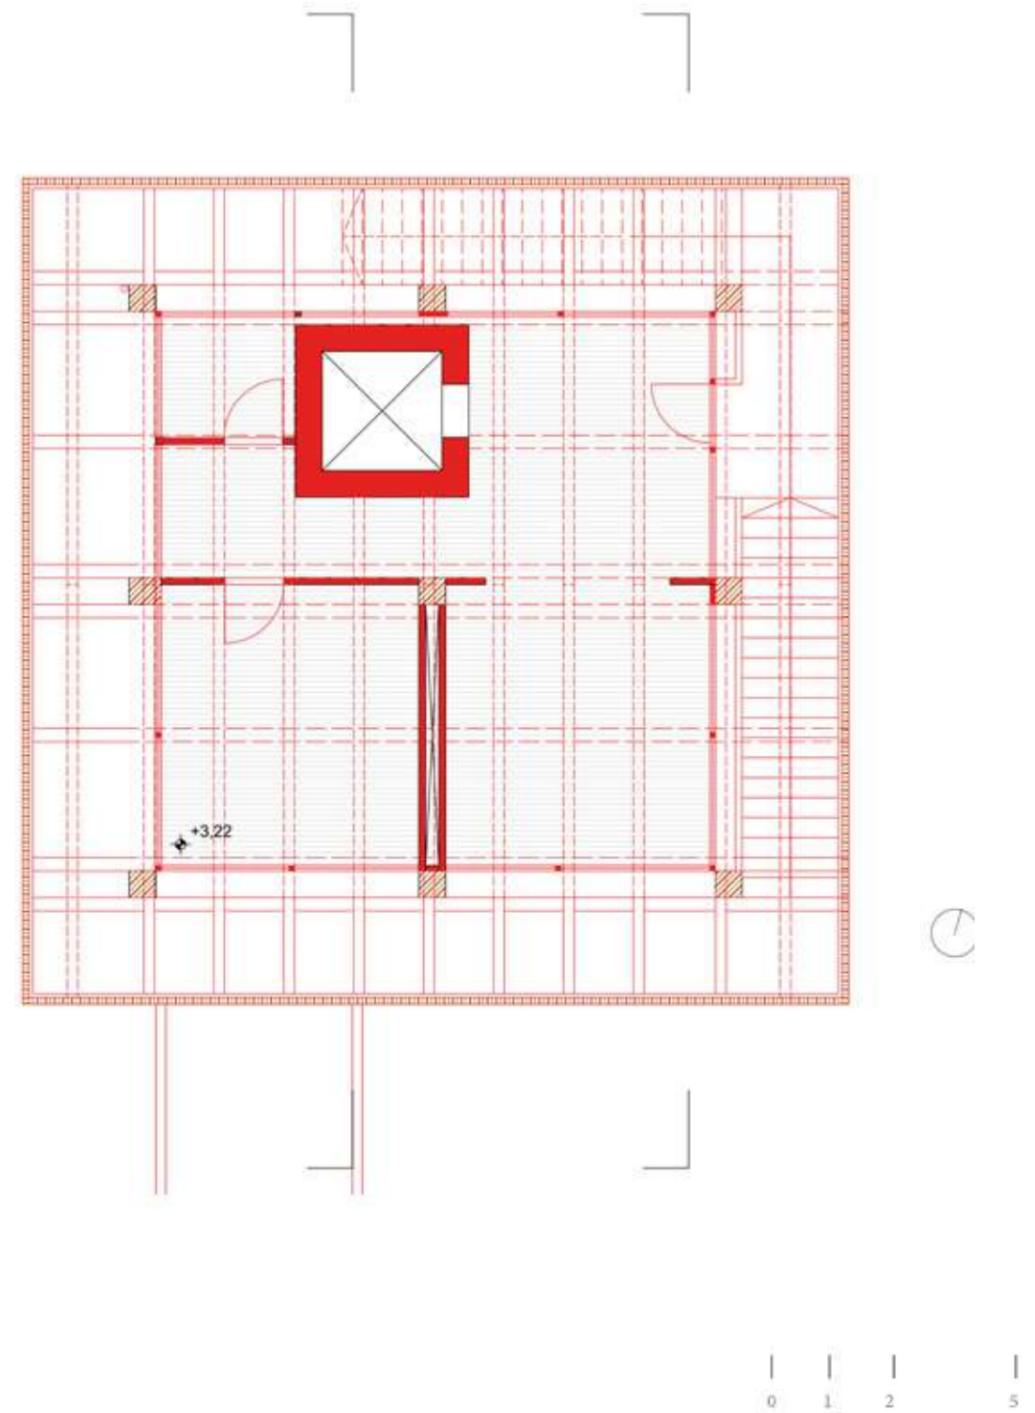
Grundriss 1. Obergeschoss Jagdkanzel, M 1:100
